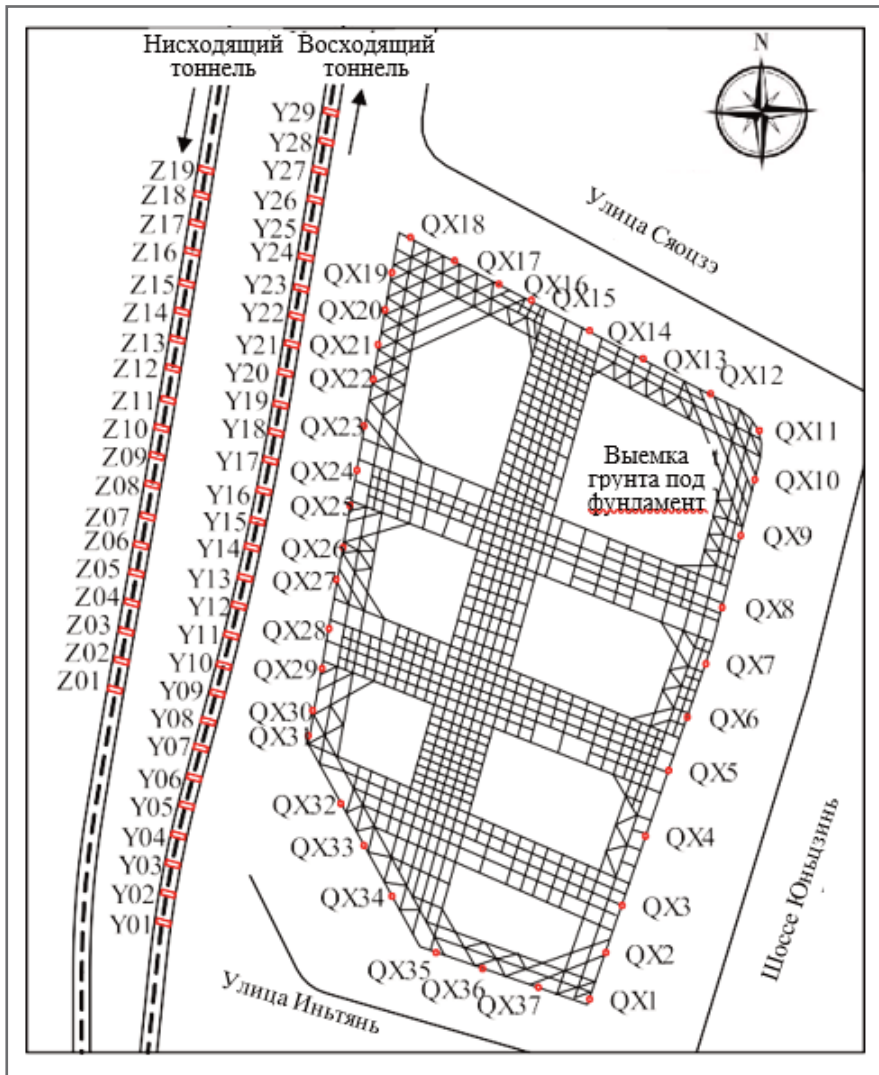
План расположения наблюдаемых участков в выемке грунта под фундамент и тоннелях
